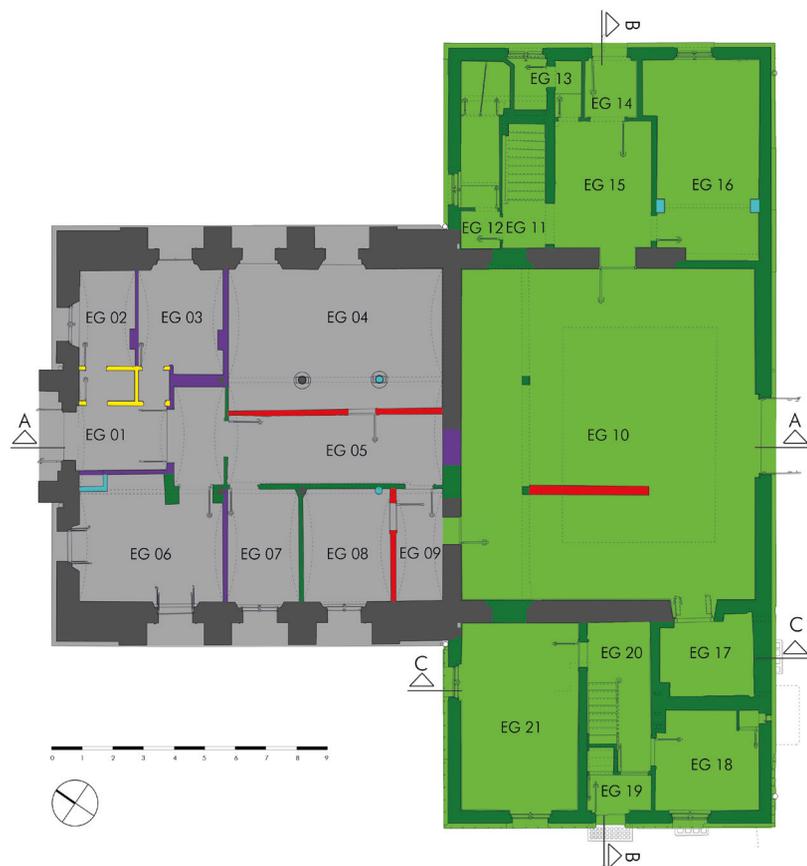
Grundriss Erdgeschoss, Bauphasenplan.
